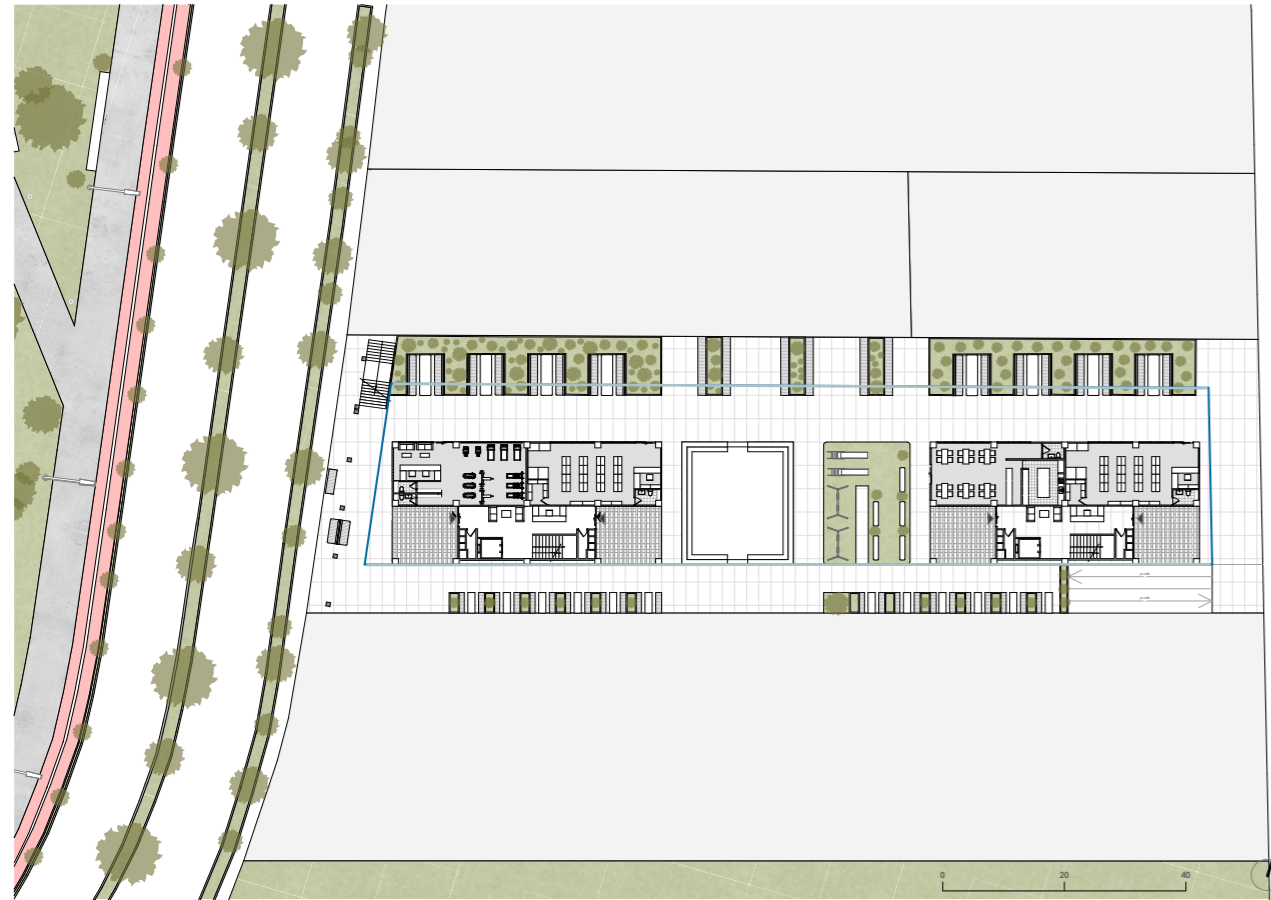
Planta Baja lote 1. Fuente: Autoría propia (2026)
